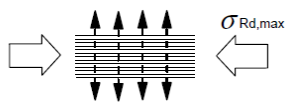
Valor de cálculo da resistência de escoras de betão sujeitas a trações transversais
